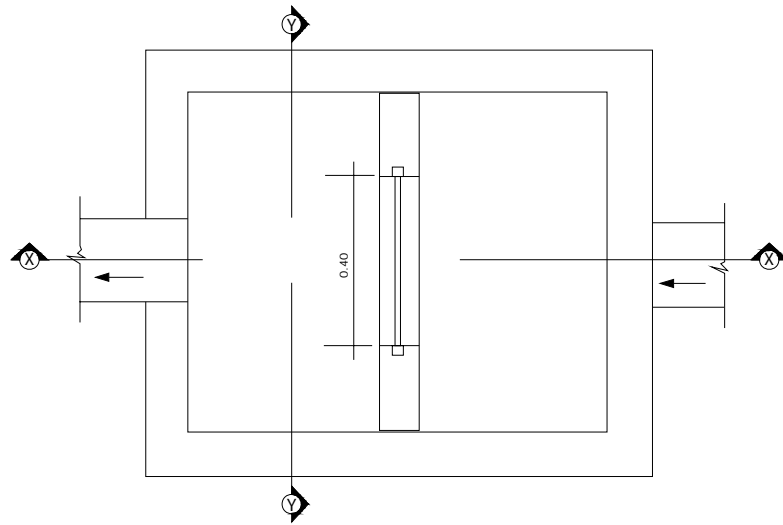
Detalles de las estructuras de entrada – Obras de arte No 2 y No 3.
